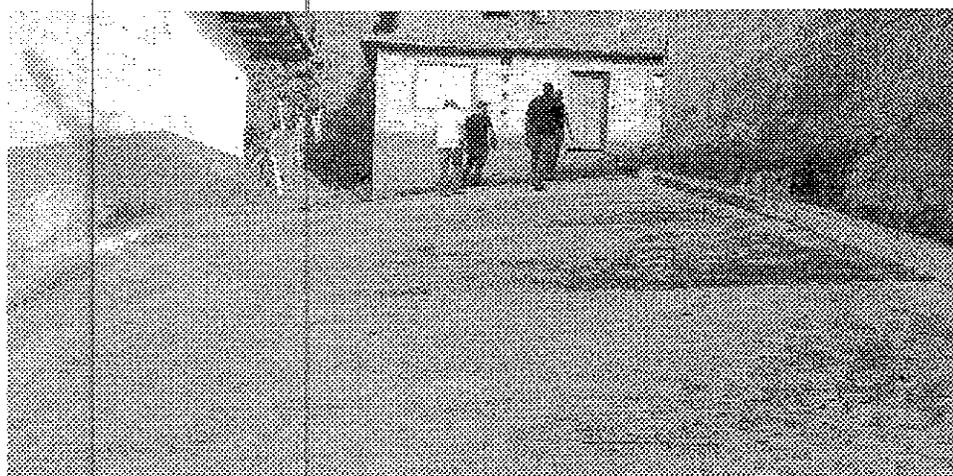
Pavimentación de las vías urbanas, Barrio La Esperanza – área conformación y pavimentación
